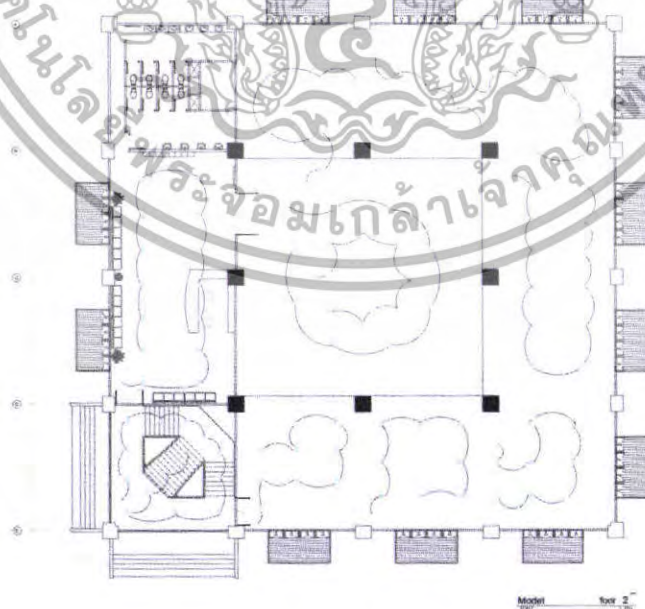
แสดง LAY – OUT PLAN FURNIYURE ชั้นที่ 1
